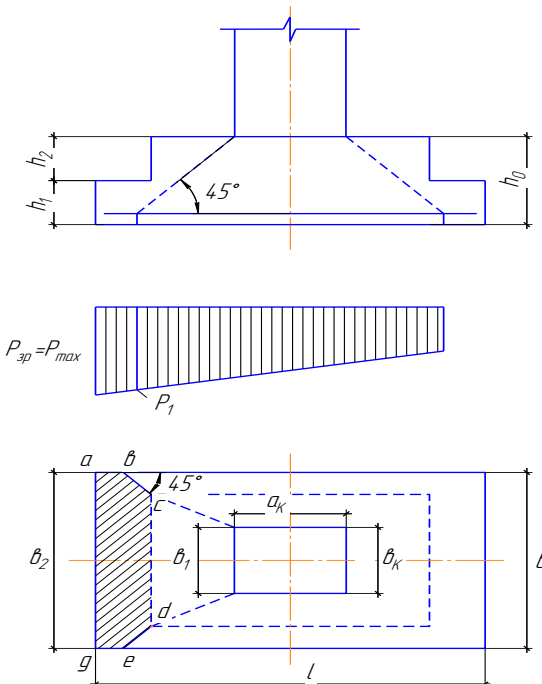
Схема для розрахунку фундаменту на продавлювання.
